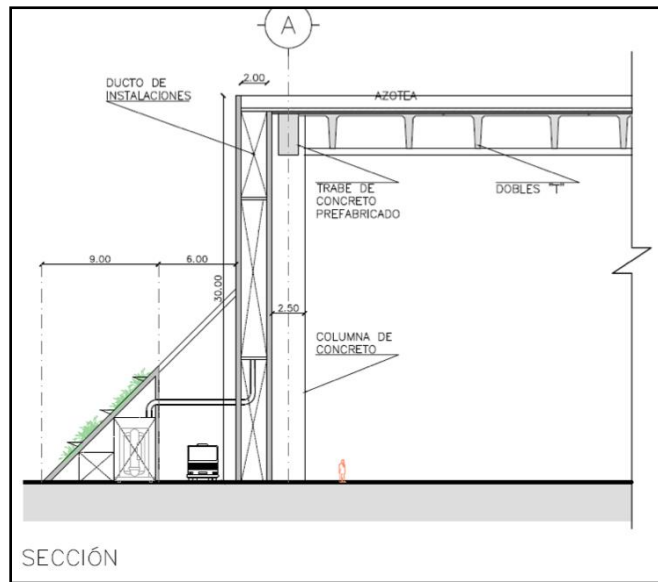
Se observa el detalle de la estructura y el talud que por fuera cubrirá las instalaciones, será una cubierta verde (con vegetación).
